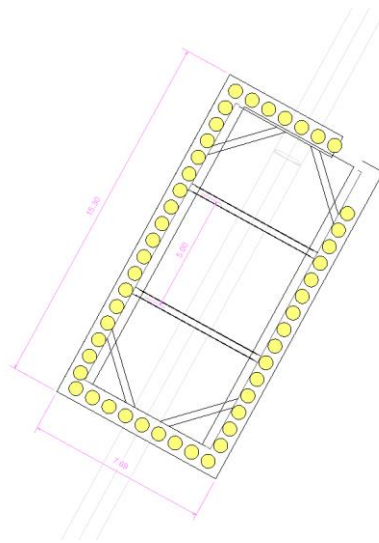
Planimetria opera provvisoriale – Microtunneling A.
